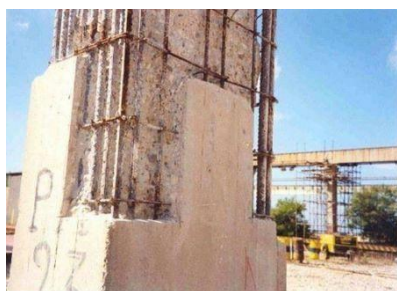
Remoção do betão das áreas degradadas de um pilar
